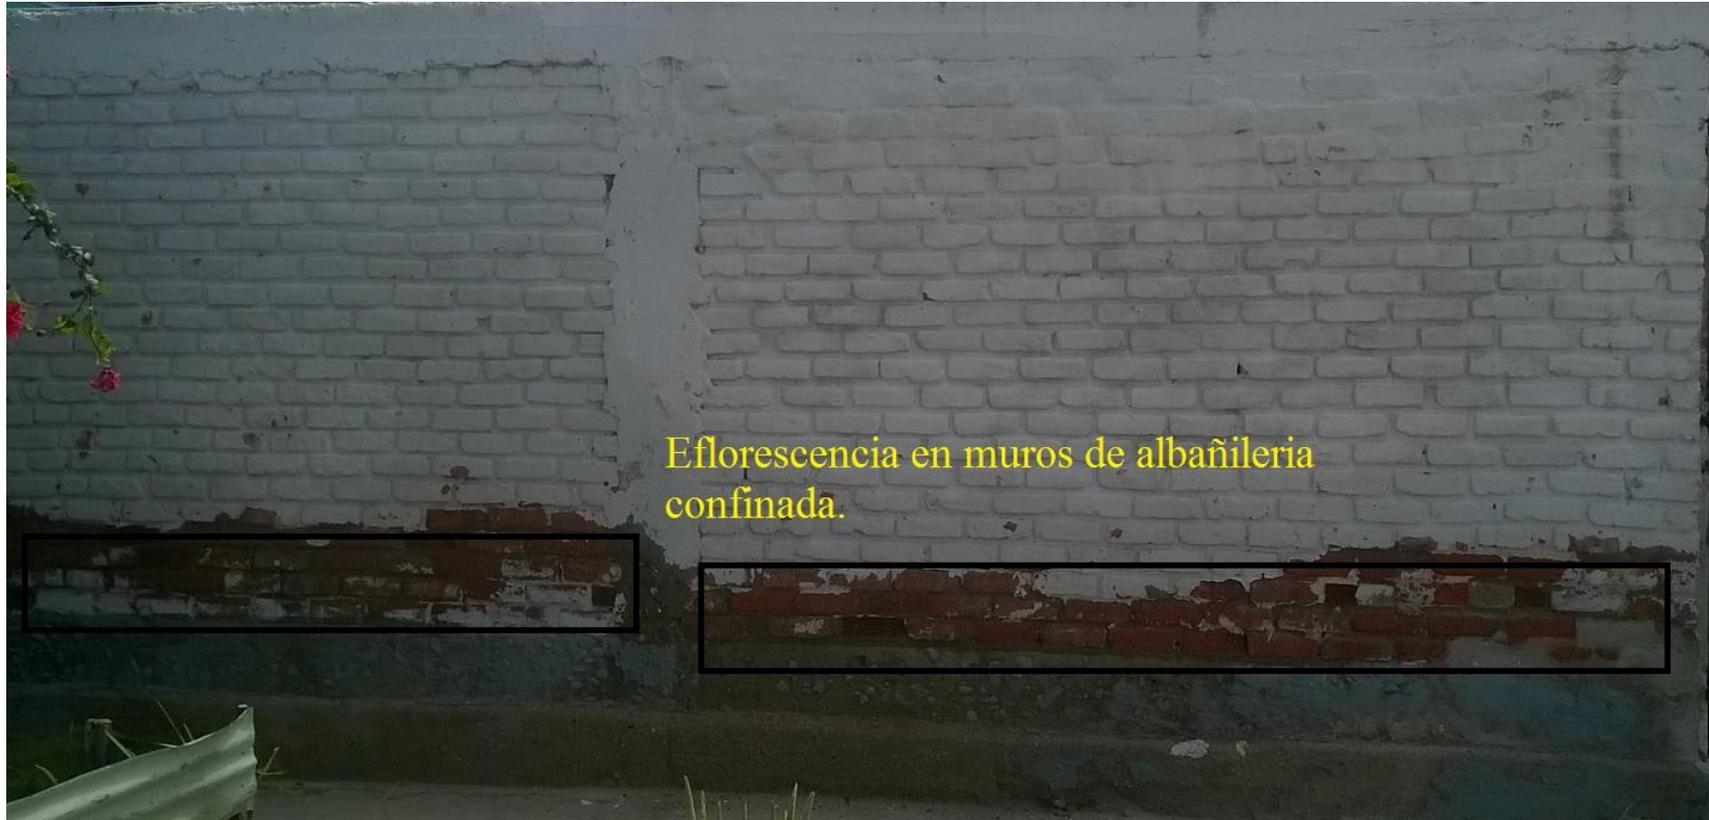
Eflorescencia en muros de albañilería confinada.
